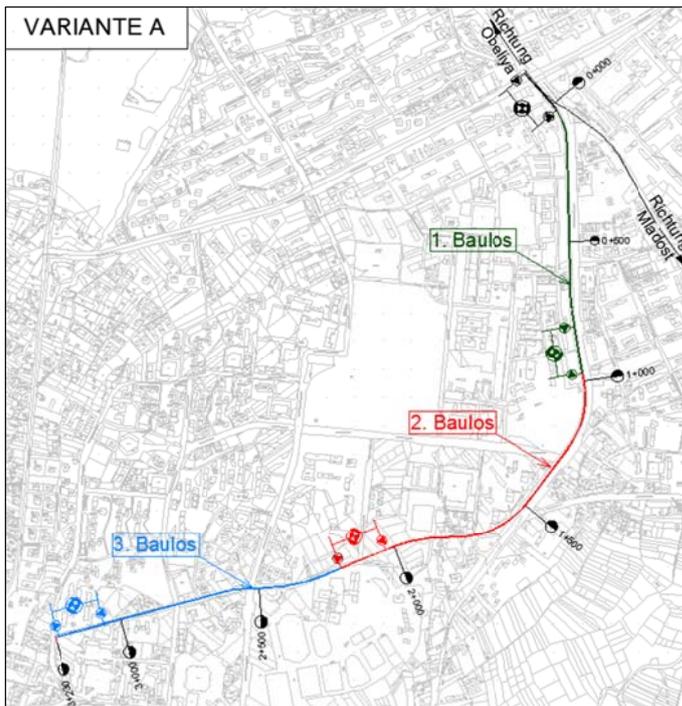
Lageplan - Variante A – Baulos 1÷3
